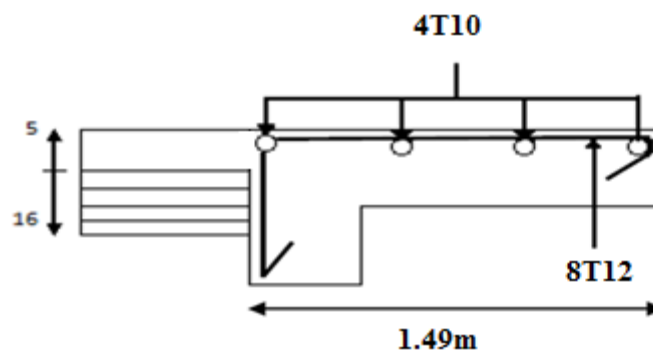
Dessin de ferrailage de la dalle pleine de type2.
